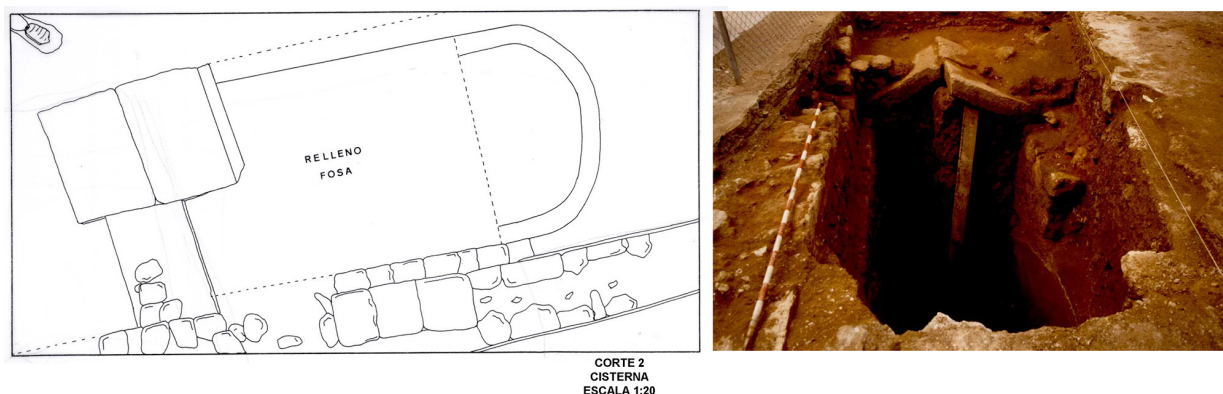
Detalle de la planimetría y cubierta de la cisterna de la c/ Viento, 4 (elaboración propia a partir del original tomado de Mata, cit. n. 13).
